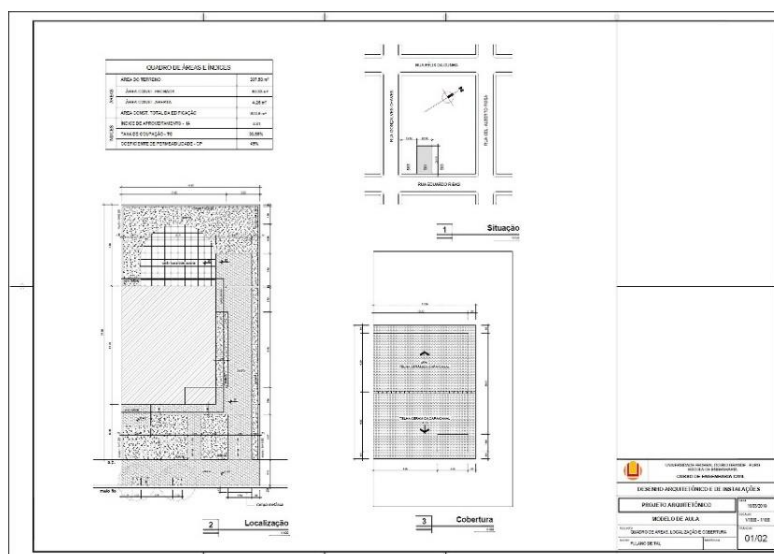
Exemplo de disposição de desenhos na folha: quadro de áreas, planta de situação, planta de localização e planta de cobertura. Fonte: autor
